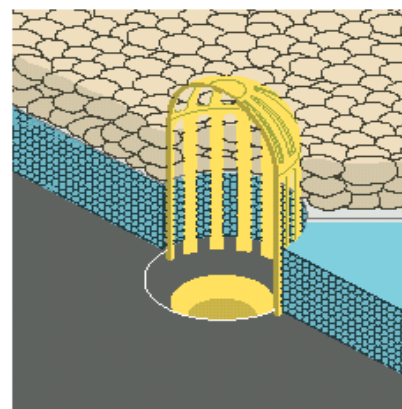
Ejemplo de entrega en sumidero. Instalación de planchas de XPS en cubierta plana invertida¹.
